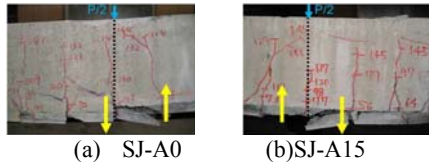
終局状態におけるRCはりのひび割れ状況
